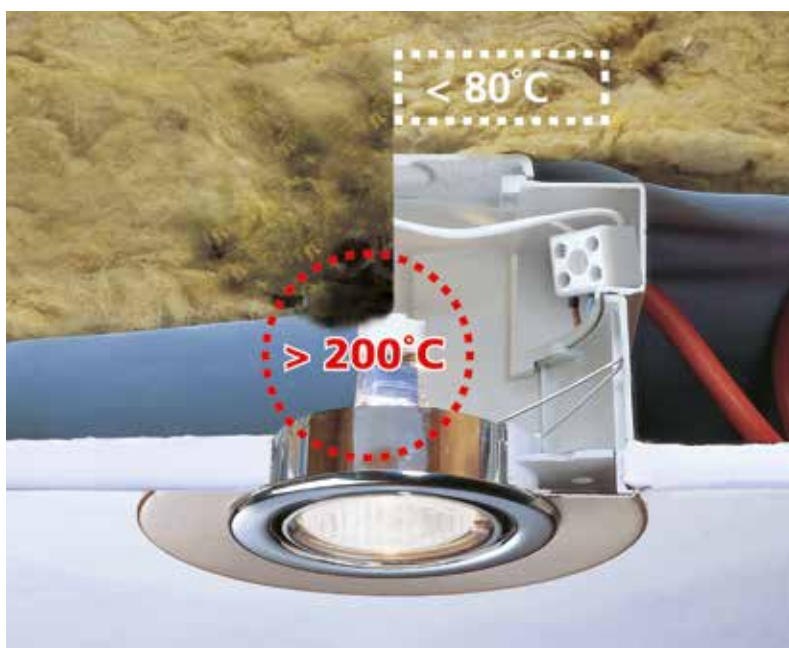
Einbau einer Halogenleuchte unterhalb der luftdichten Schicht einer wärmegeämmte Decke
